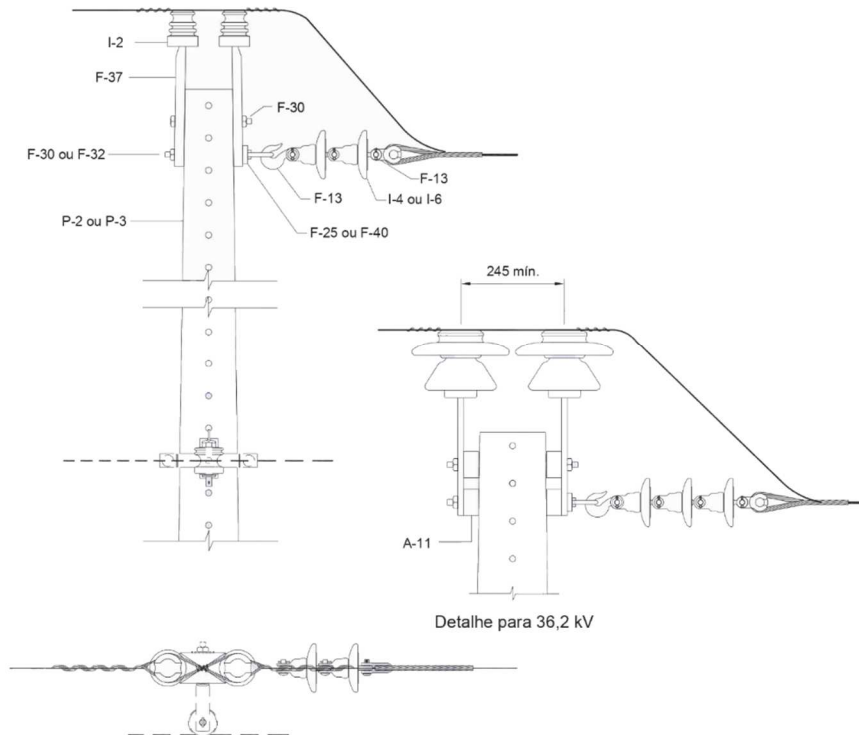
Primário – Estrutura U3-2 – Poste de concreto de seção circular
